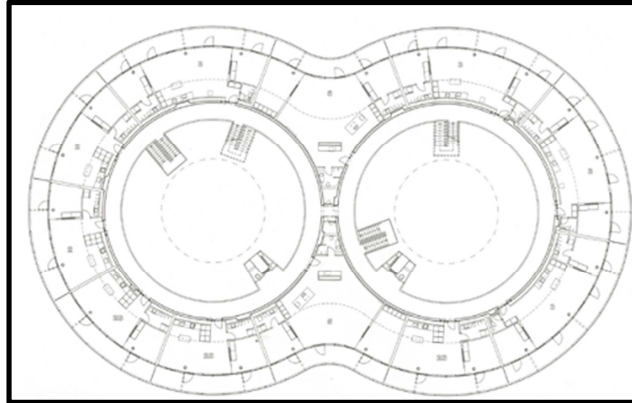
Plan des appartements au 5eme étage, source: Etude d'une pensée constructive d'architecte, Gemini résidence
